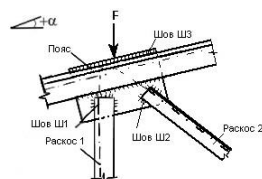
Конструкторский чертеж узла номер 9
